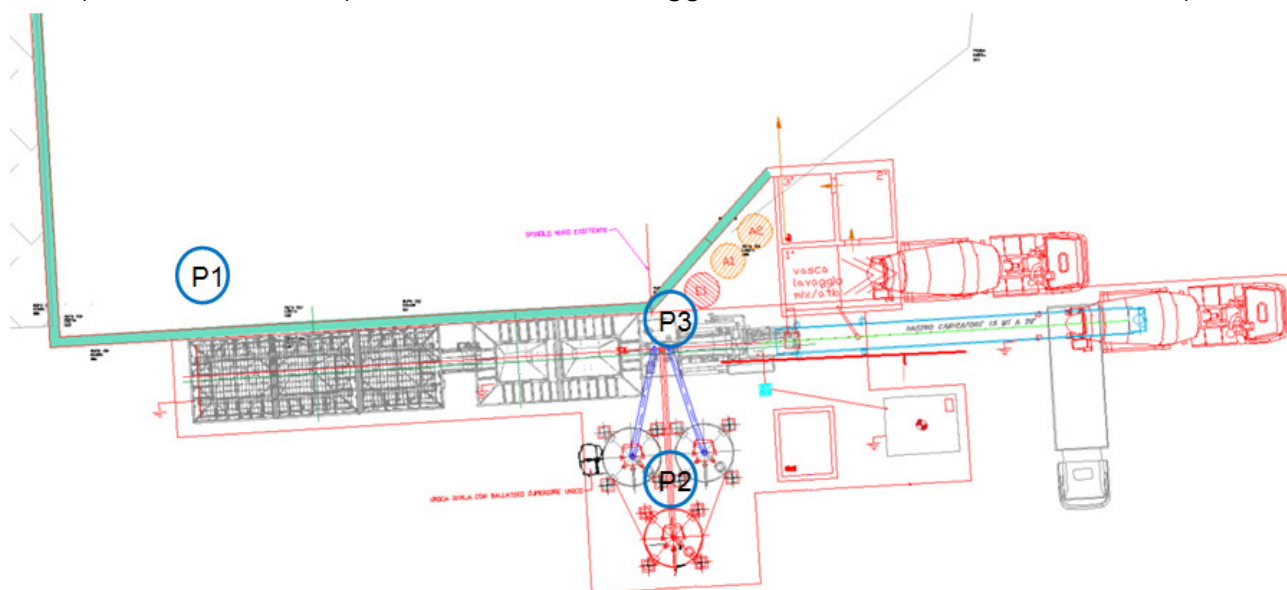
Rappresentazione dei punti di monitoraggio (P1, P2, P3) dell'impianto di betonaggio aziendale
